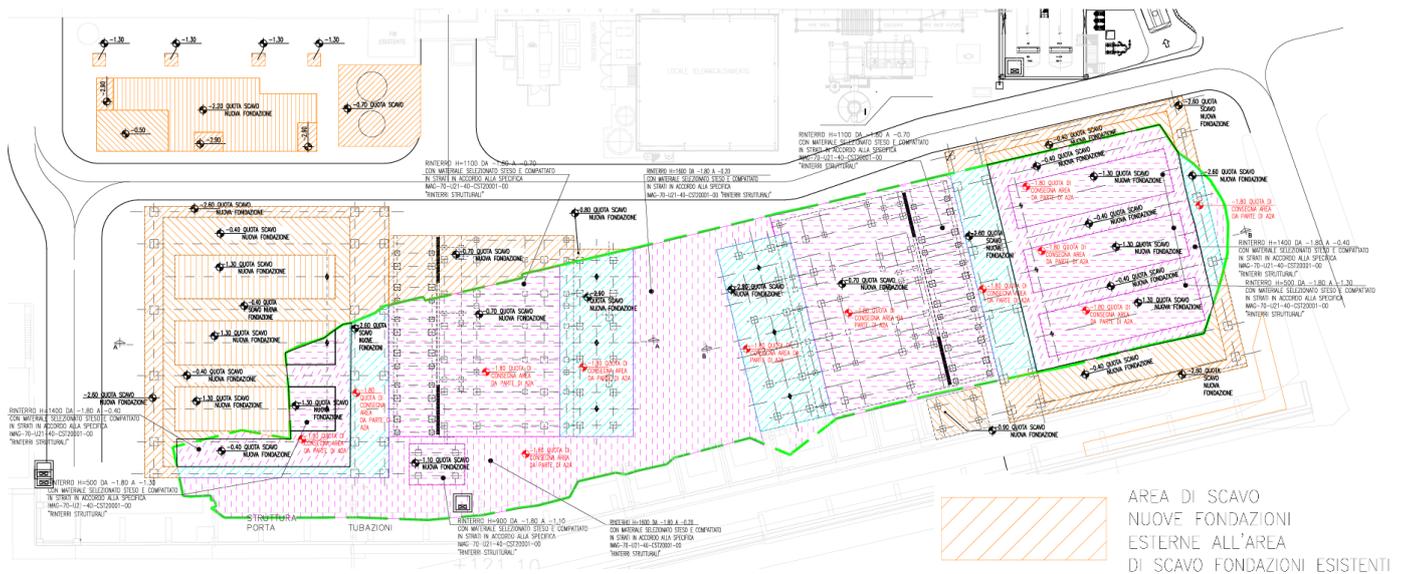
Planimetria indicativa aree di produzione delle terre e rocce da scavo
